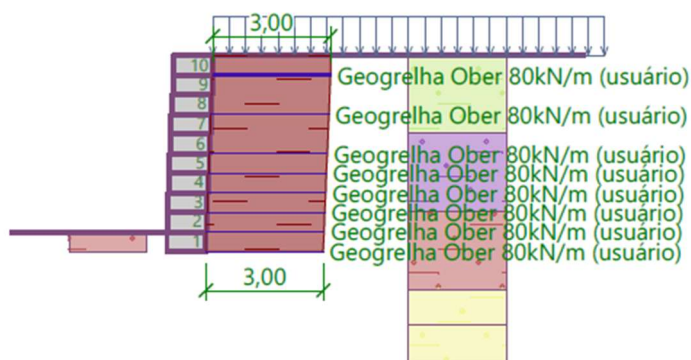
Perfil da seção de 5,0 metros do Muro 2
